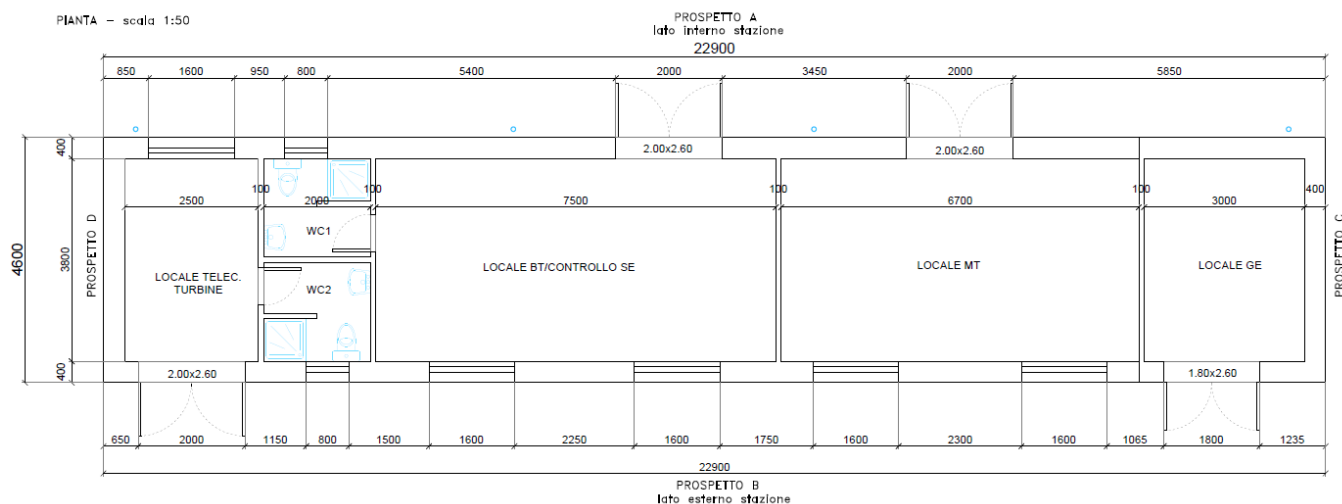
Pianta edificio utente nella configurazione proposta in variante
